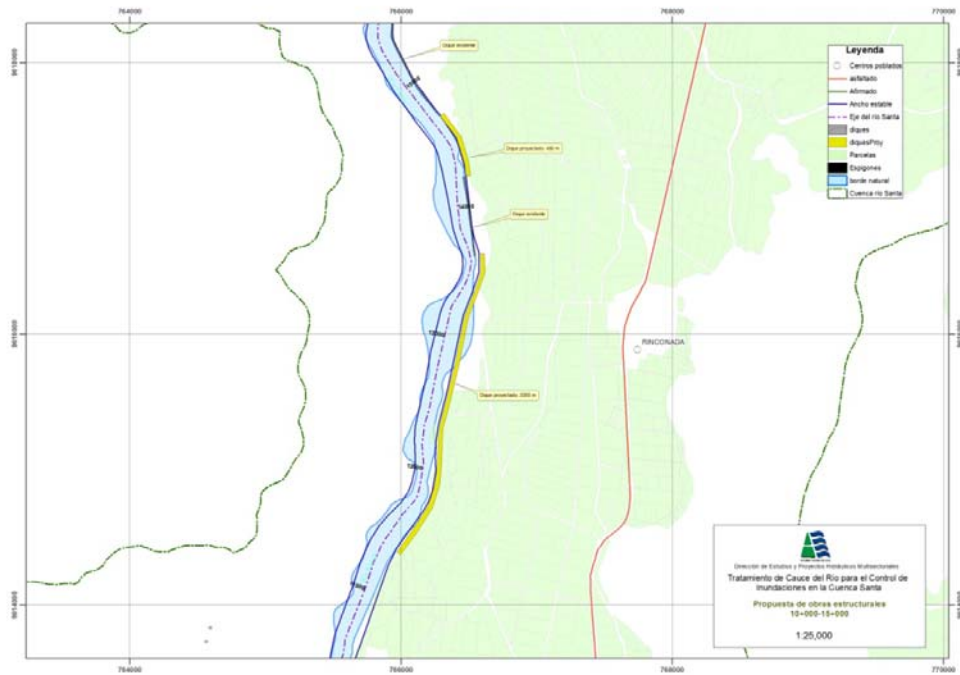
Estructuras proyectadas en el tramo 10-15+000
